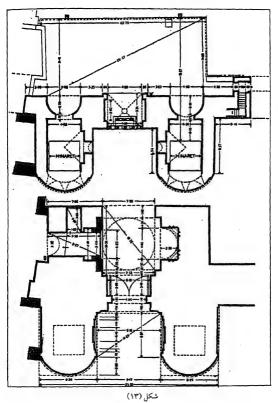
باب الفتوح، مسقط أفقي عن كريسويل
